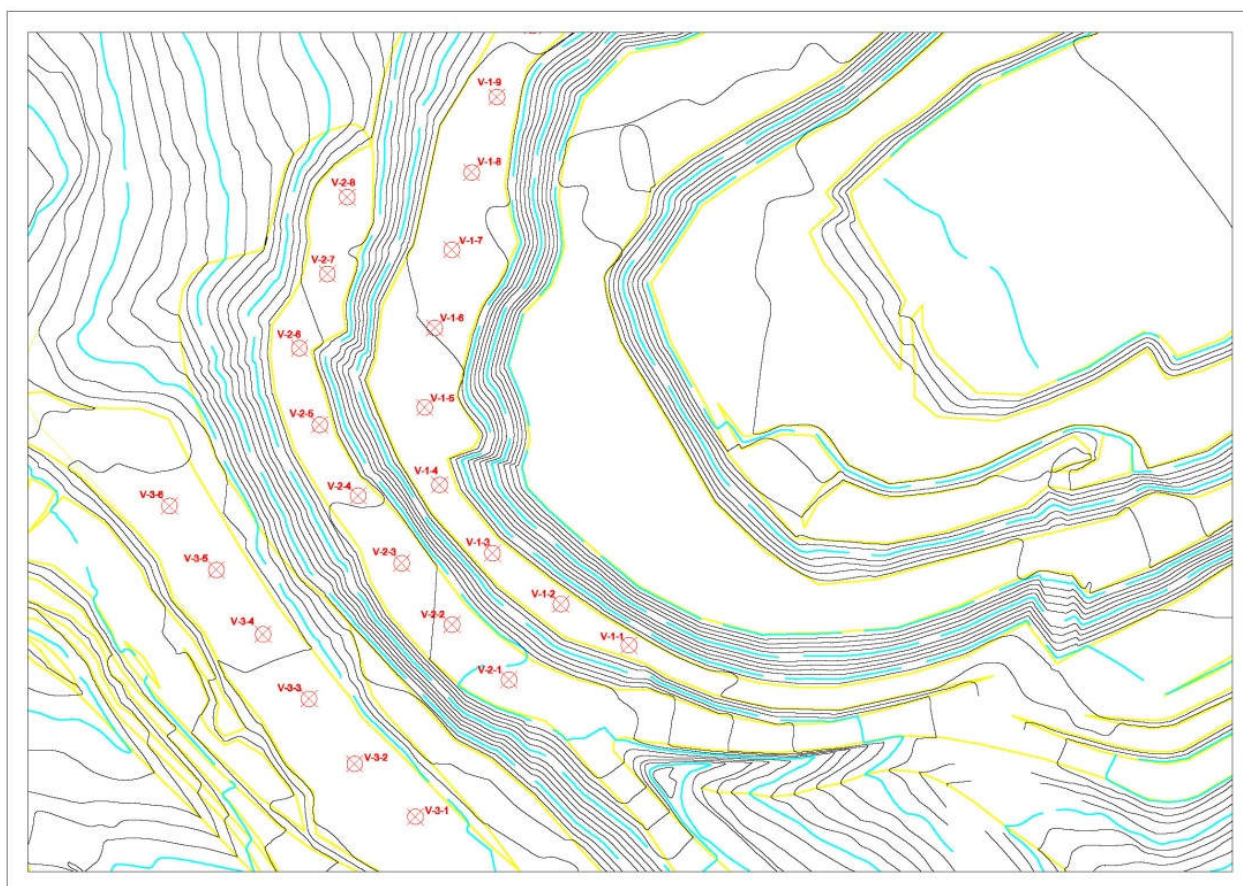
Planimetria riportante l'ubicazione dei sondaggi realizzati
